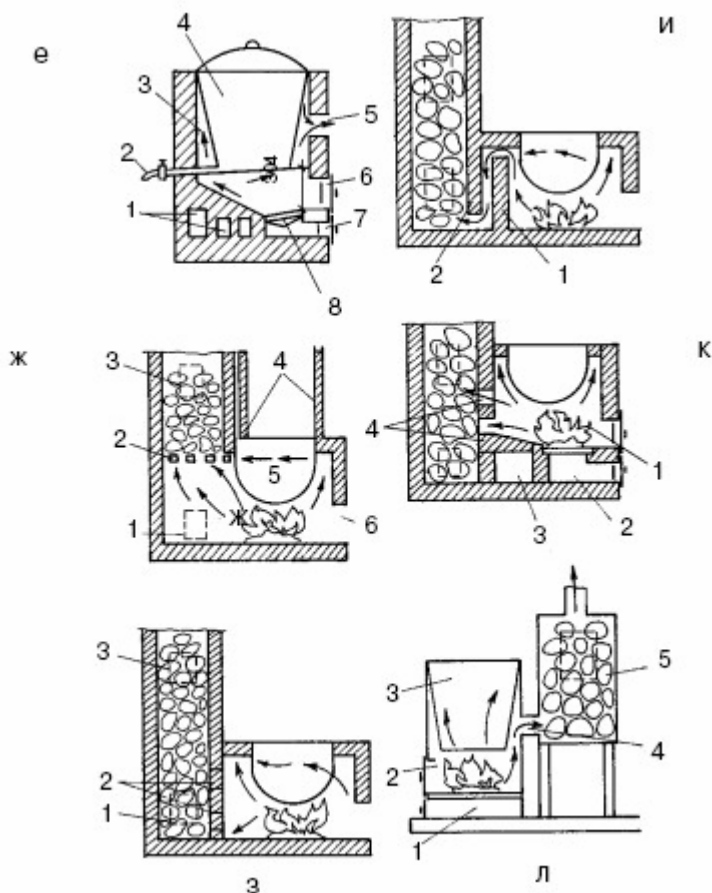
(продолжение). Баня (размеры даны в см и мм): е – печь для отопления и нагрева воды: 1 – каналы для выхода тепла; 2 – кран; 3 – пазуха для горячих газов; 4 – котел; 5 – канал для отвода газов в трубу; 6 – топочная дверка; 7 – поддувальная дверка; 8 – колосники; ж – простая печь-каменка: 1 и 3 – дверки; 2 – чугунные колосники; 4 – проволока или тросик; 5 – котел; 6 – топливник; з – улучшенная печь-каменка: 1 и 3 – дверки; 2 – отверстия в стенке топливника; и – печь-каменка с дополнительной стенкой: 1 – стенка внутри топливника; 2 – отверстие в стенке камеры; к – печь-каменка с поддувалом: 1 – топливник; 2 – зольник; 3 – канал для выхода горячих газов из-под
